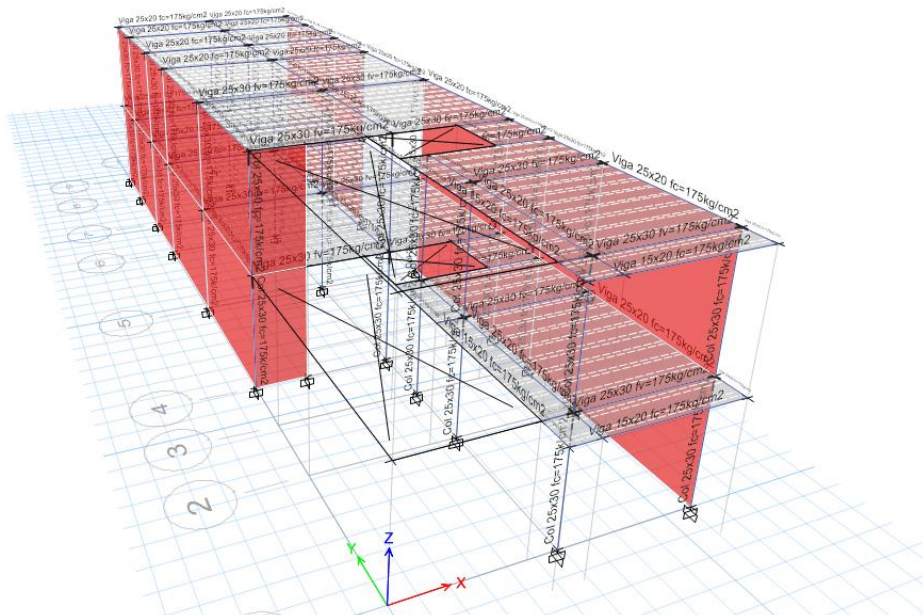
Vista tridimensional de la vivienda 2 reforzada con placa de concreto armado. Fuente: propia.
